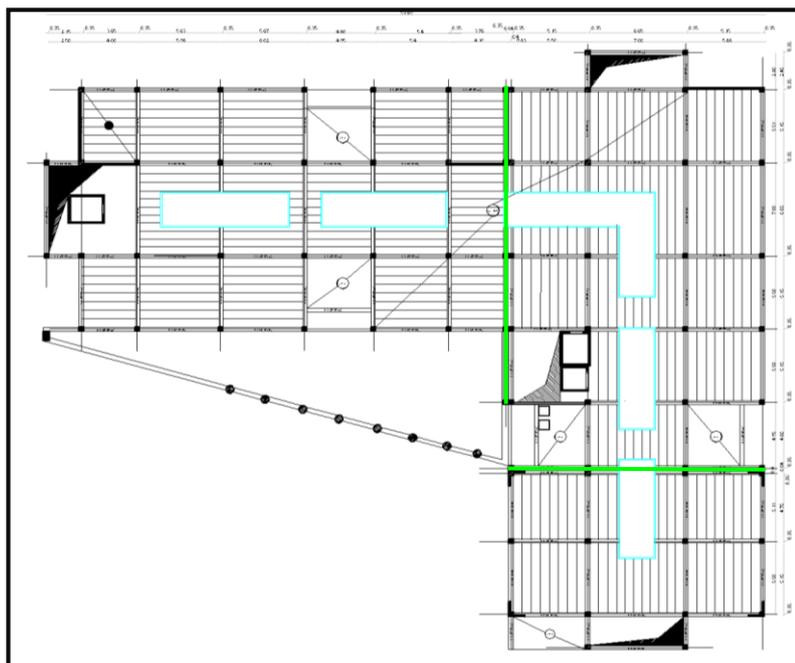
plan de coffrage +3.60 de la polyclinique
